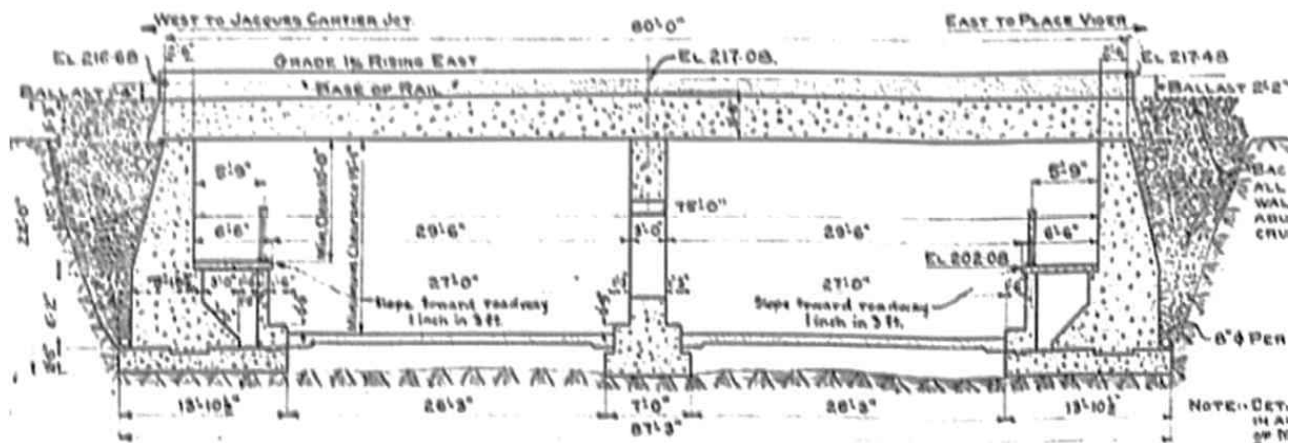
Pont ferroviaire P.F. 81-5170B – Extrait des plans 5170-1951 - Vue en élévation
